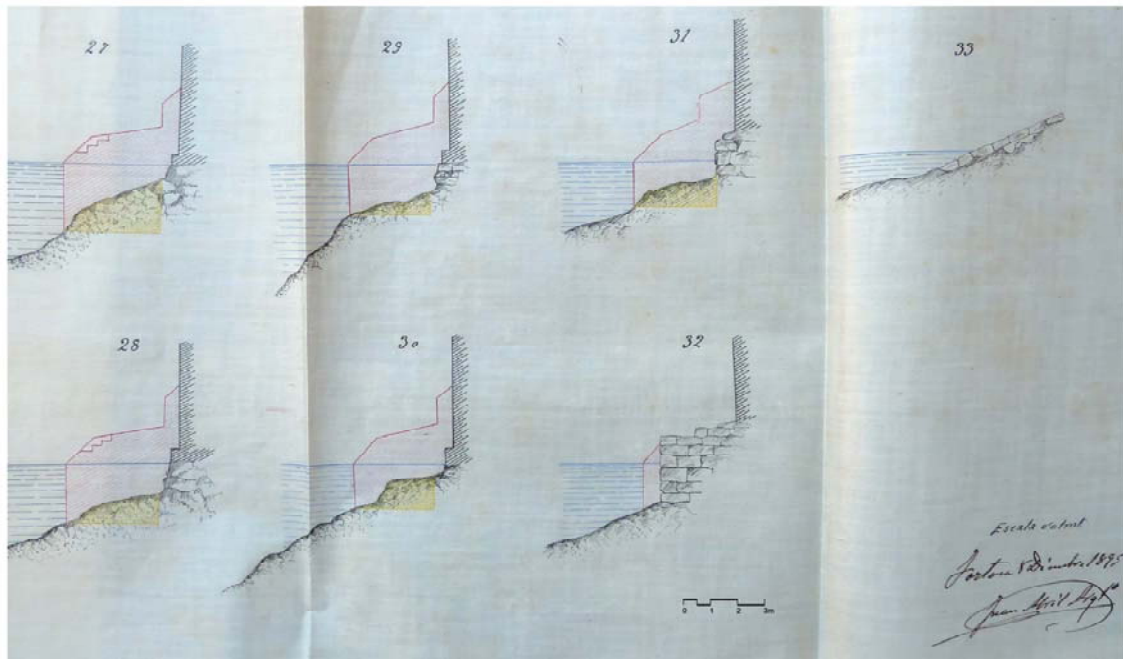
Proyecto de restauración de Abril i Guanyabens: Secciones
